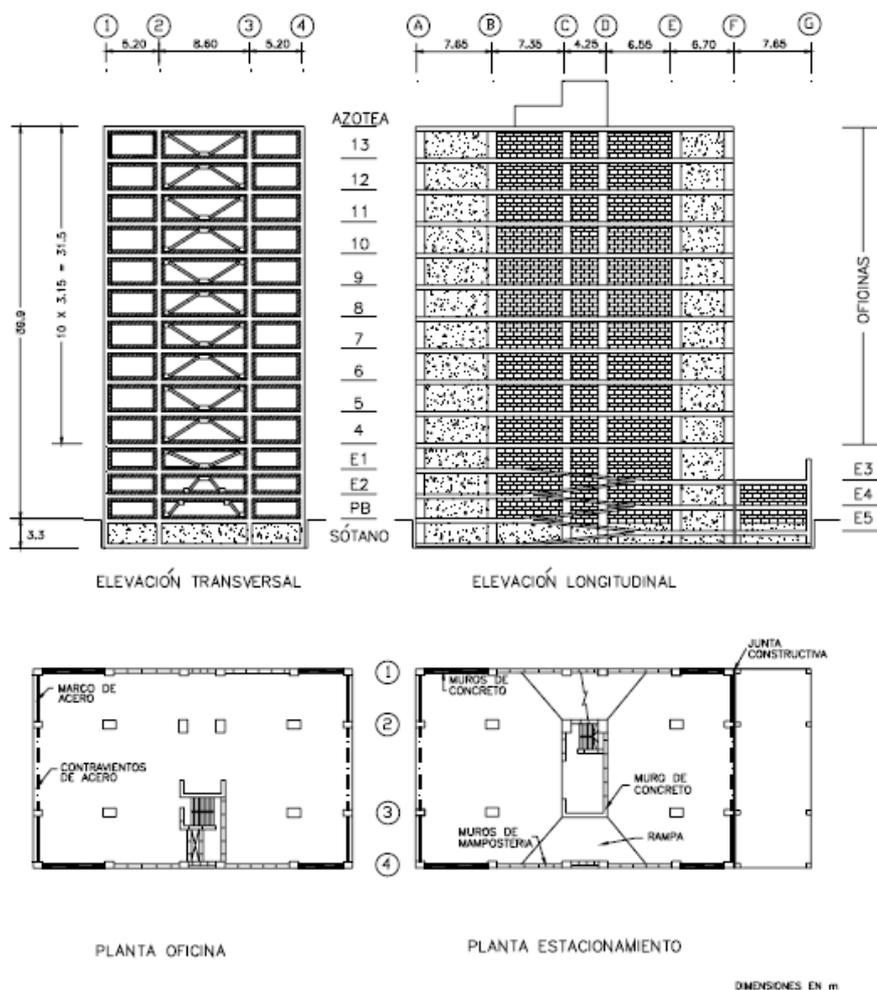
Plantas y elevaciones del edificio Jalapa.
